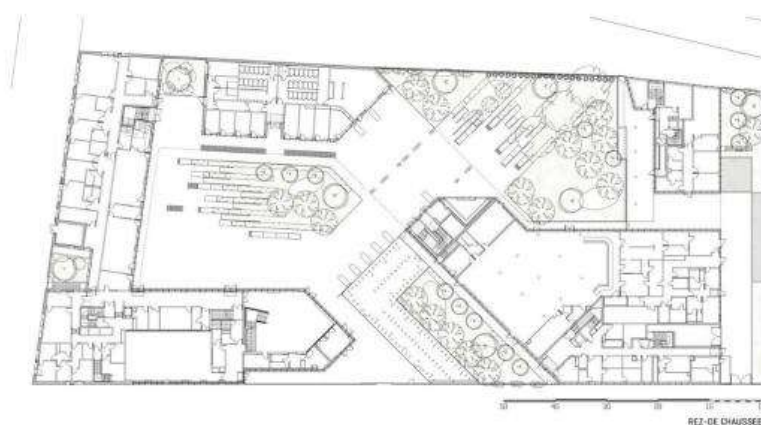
Генеральний план сумісний з планом першого поверху [7]
